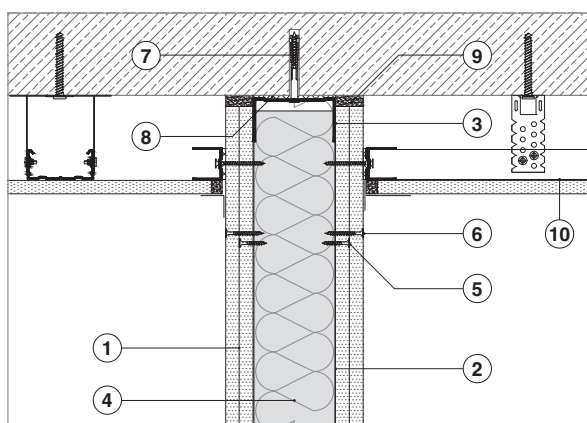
Conexiunea directă a peretelui într-o placare de plafon NORGIPS
